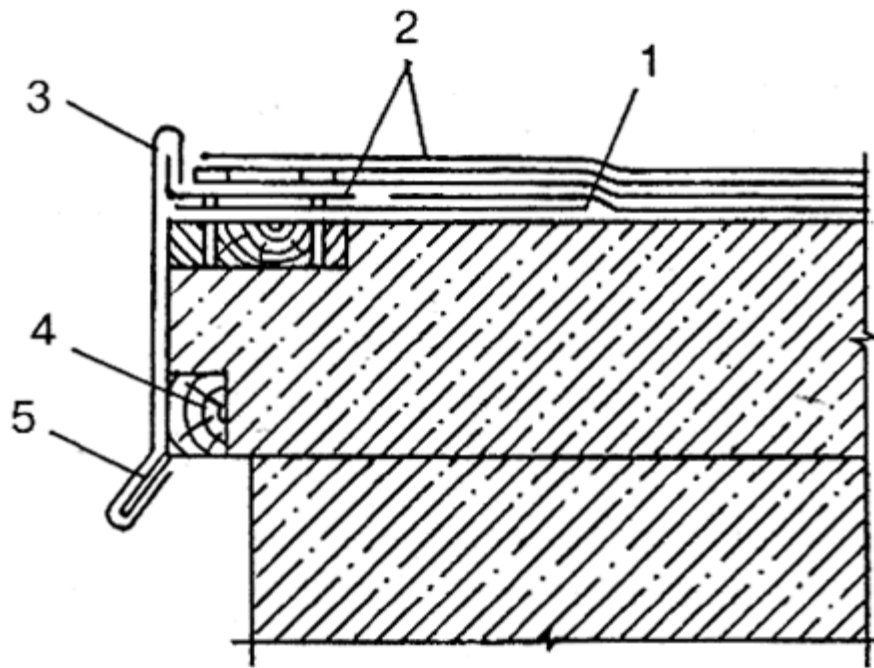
Рулонные кровли. Покрытие фронтонного свеса
